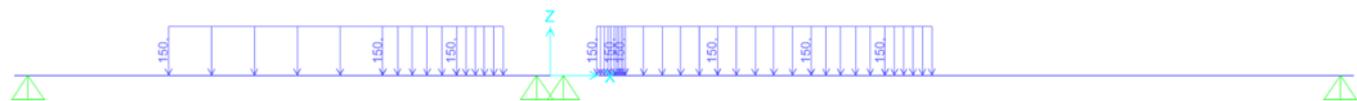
disposizione di carico 3 - SW/2 – pila 3
